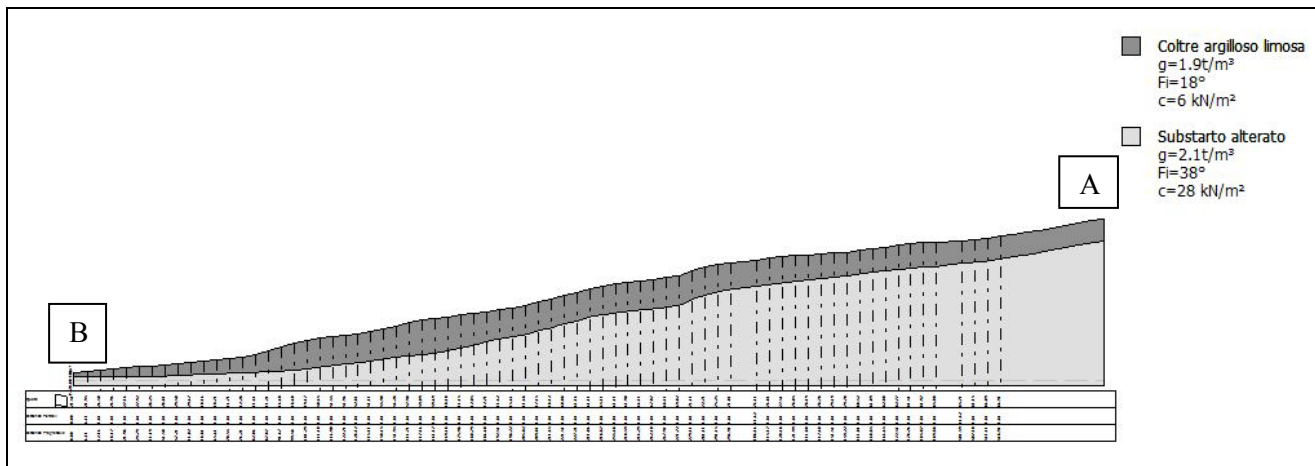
Planimetria della sezione litotecnica “Vidiciatico”
